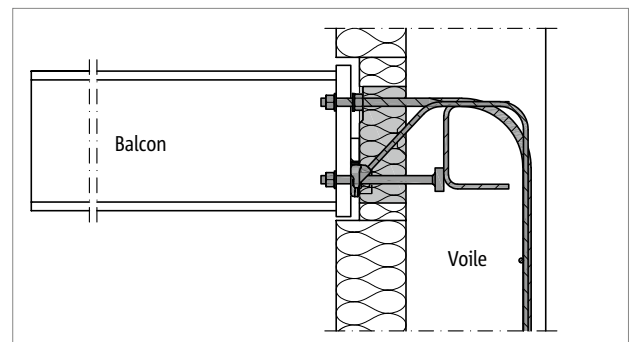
Schöck Isokorb® T type SK-WU-M1 : Construction spéciale pour raccordement mural basé sur le niveau de charge principale M1 pour des épaisseurs de paroi à partir de 200 mm
